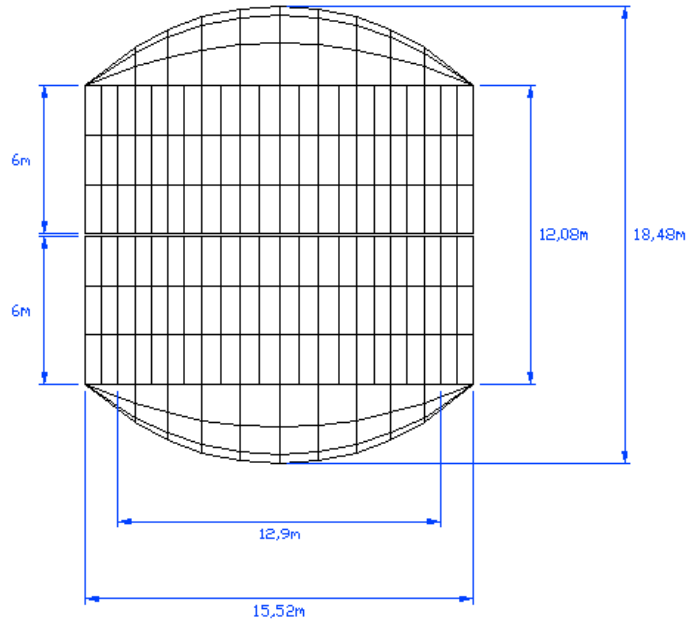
Planta de la Cubierta propuesta en la tesis.
